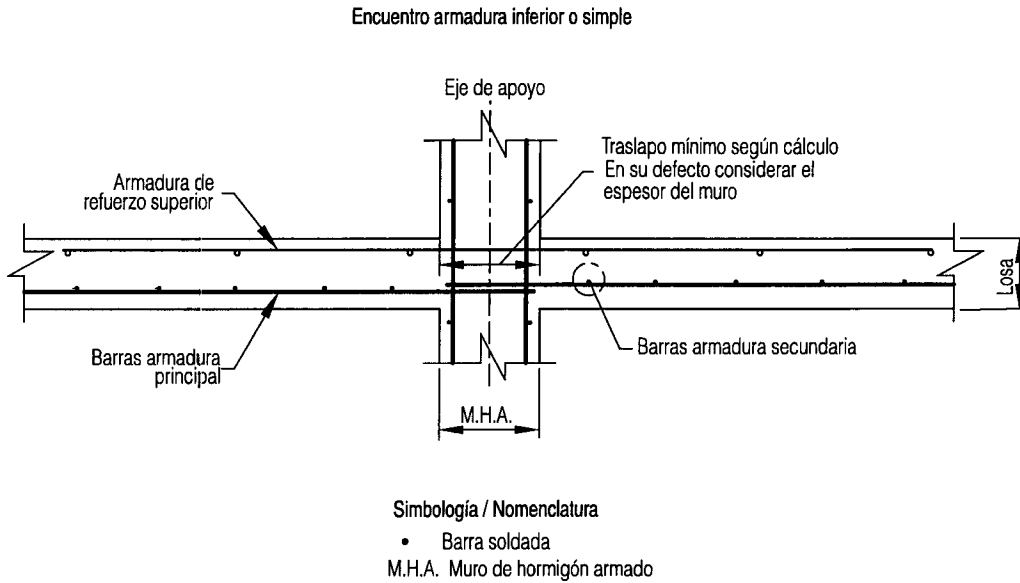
Encuentro de mallas inferior de losas con muros, opción 2
